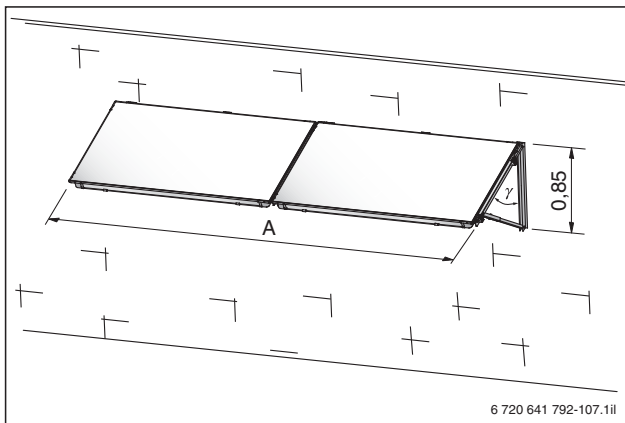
Montagemaße der Fassadenmontage-Sets für waagerechte Flachkollektoren Logasol (Maß in m)
